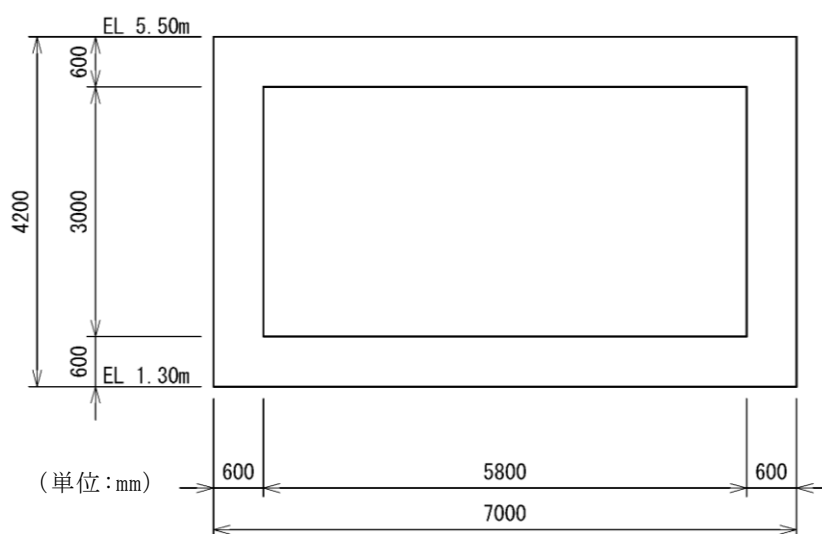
屋外配管ダクト (タービン建物～放水槽) 断面図 (A-A 断面)
